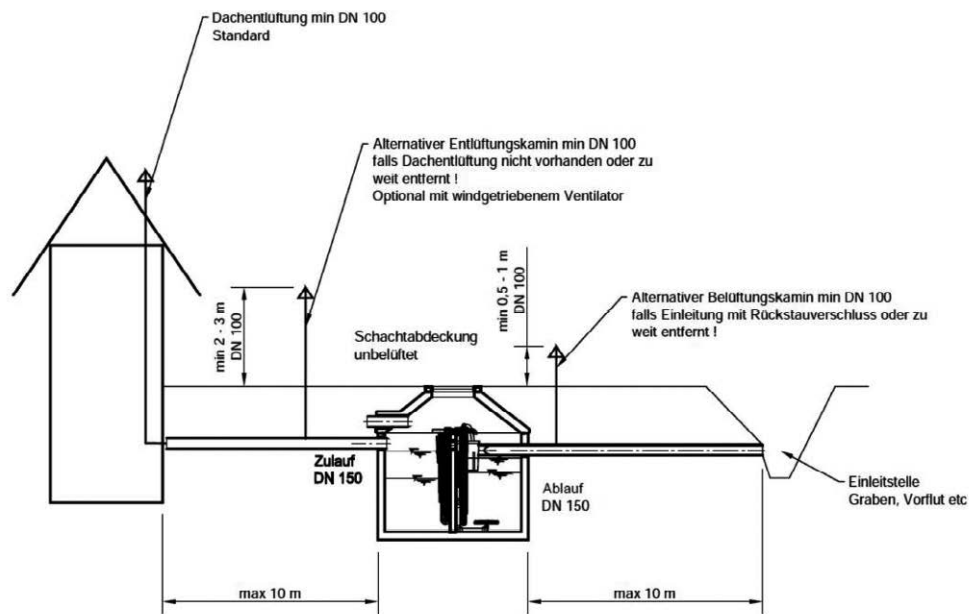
Schema zur Be- und Entlüftung bei Kleinkläranlagen
